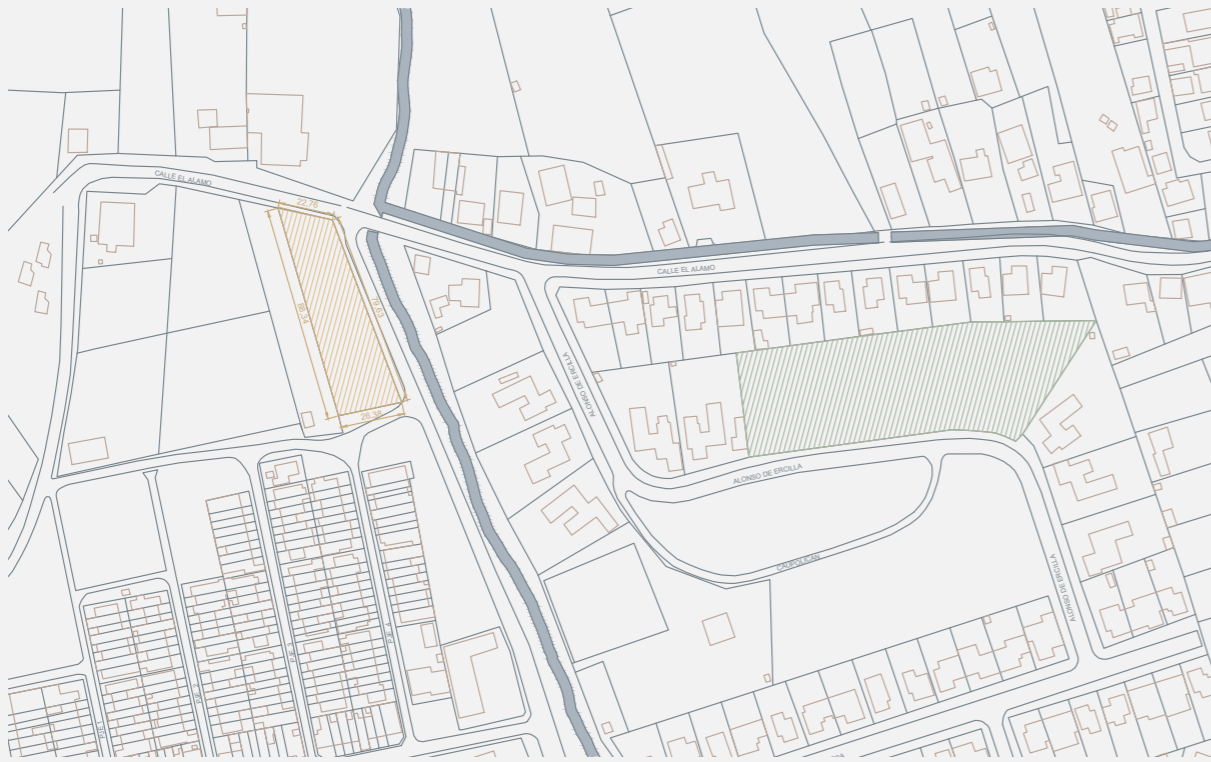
Plano emplazamiento terreno a trabajar y terreno futuro hospital de Licantén
